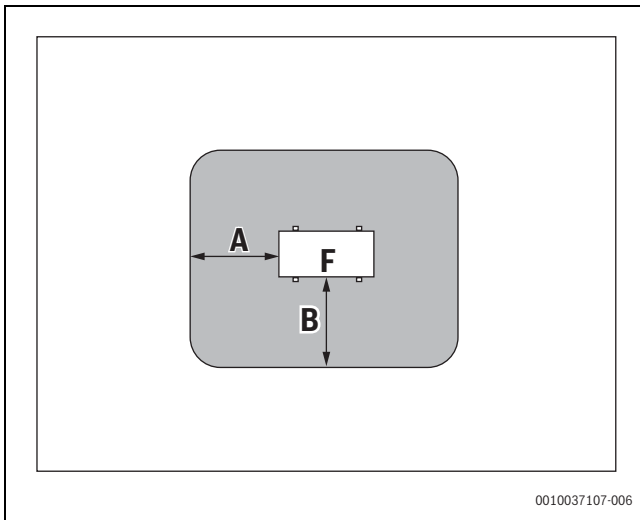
Schutzbereich bei bodenstehender Aufstellung auf dem Grundstück oder Dach
